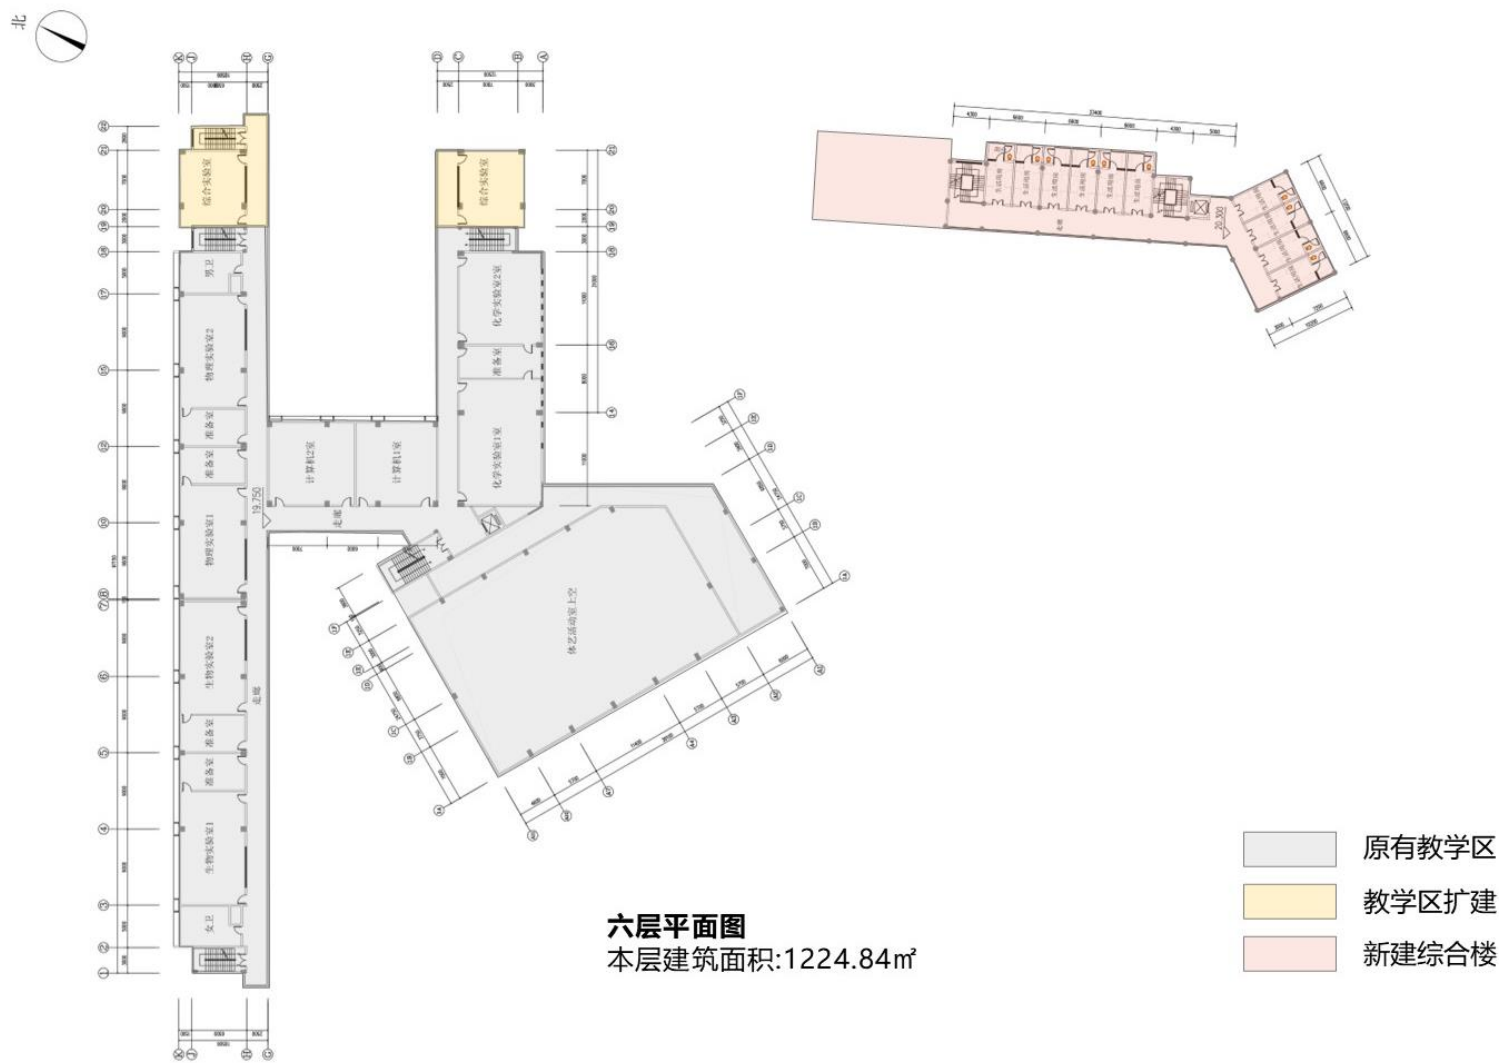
3. 3-8 新建综合楼及电梯工程六层改造平面图
